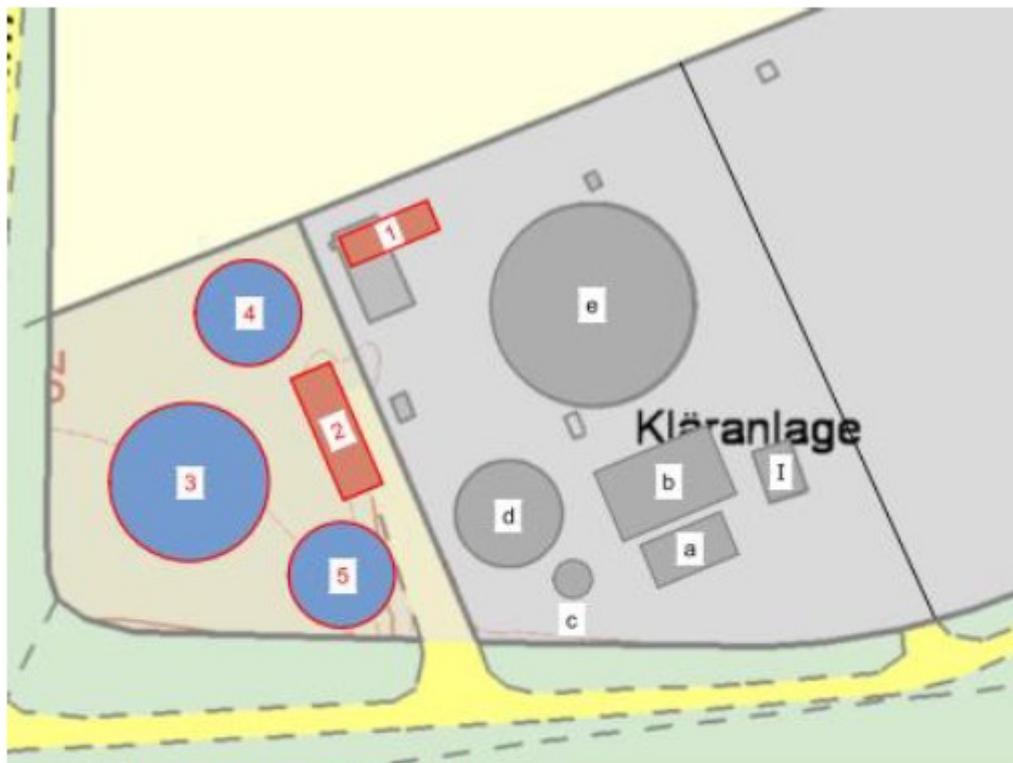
Lageplan Variante 2 / 3: Westkläranlage
